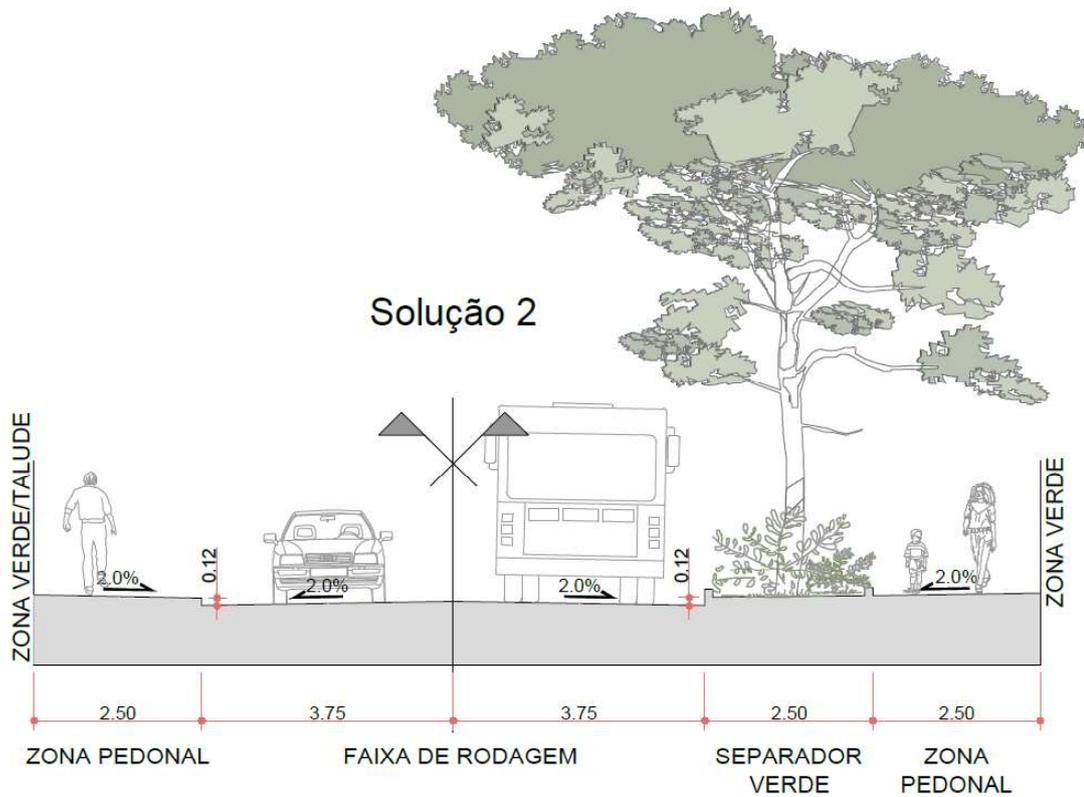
Perfil transversal da via principal do PPT. Solução 2 (AutoCad).
